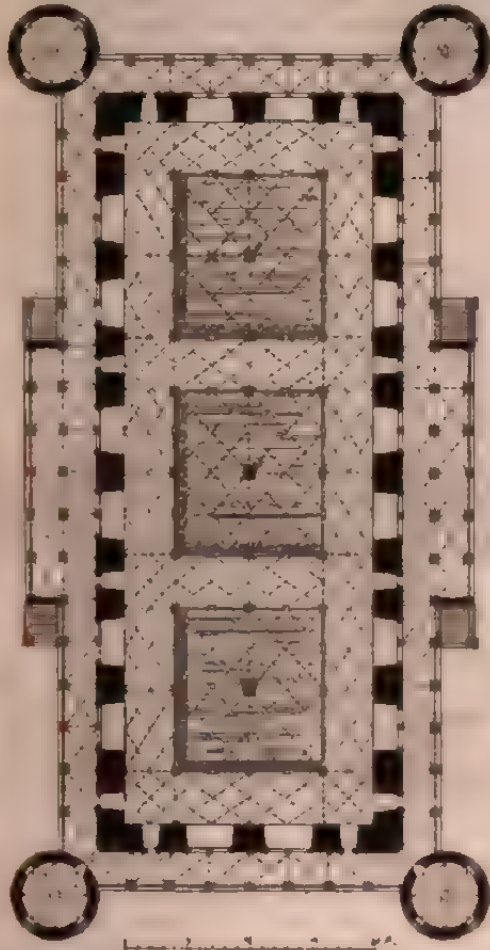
Lusthaus zu Stuttgart. Grundriss
